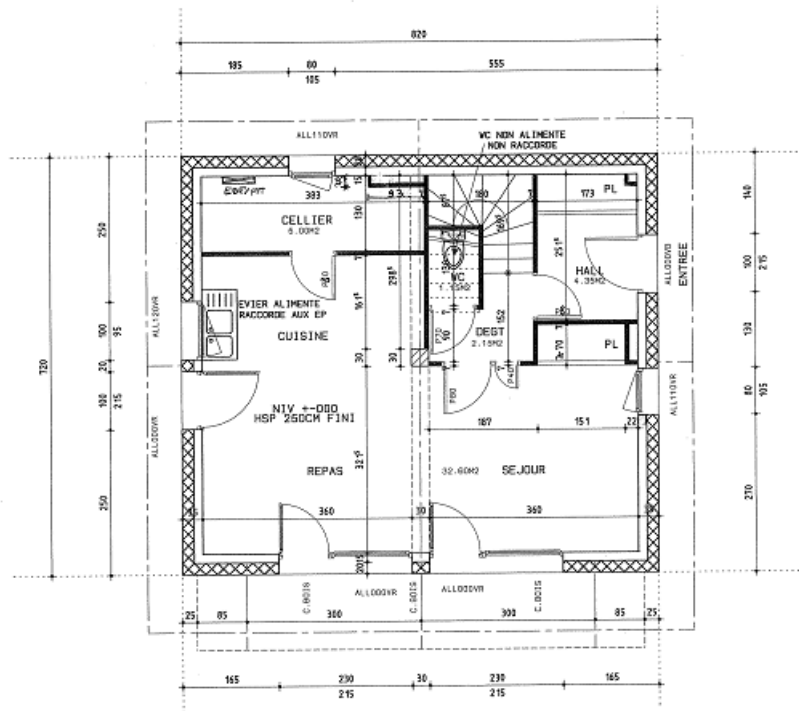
Plan du rez-de-chaussée dans la maison BB
